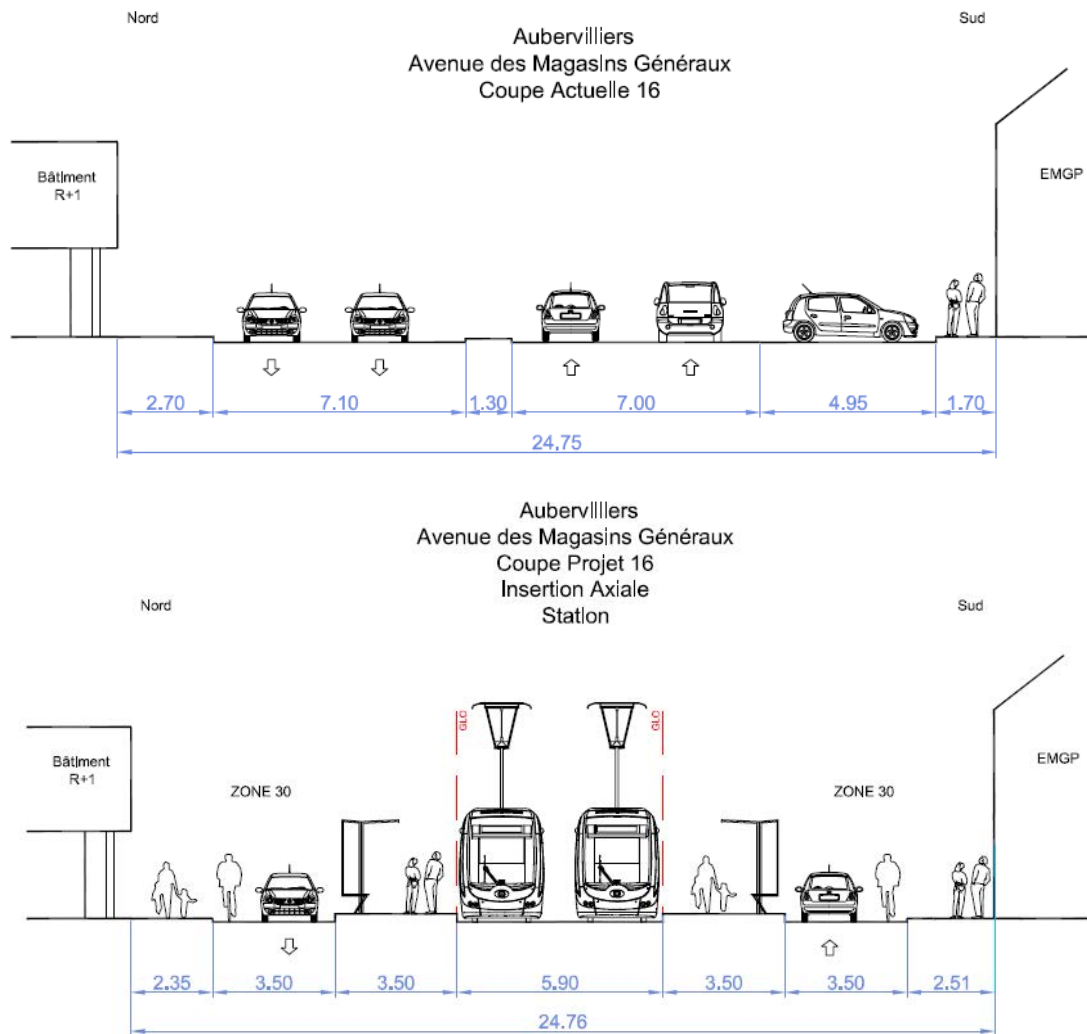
Insertion de la plateforme Tram 8 sur l'avenue des Magasins Généraux (coupe n° 16)
